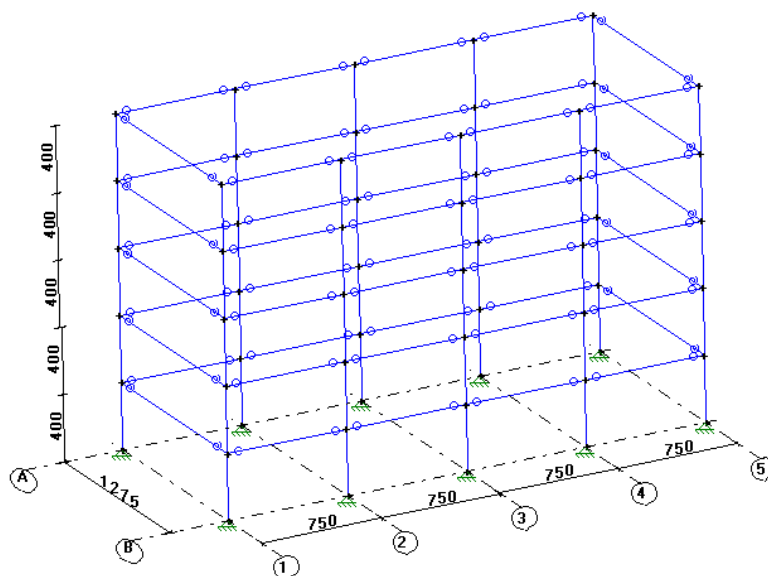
Esquema estrutural com 5 pavimentos representado por modelo de pórtico tridimensional.
